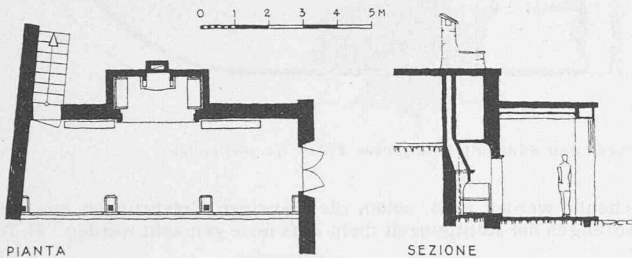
Grundriss und Schnitt des Loggia-Umbaus in Massagno. 1:200
